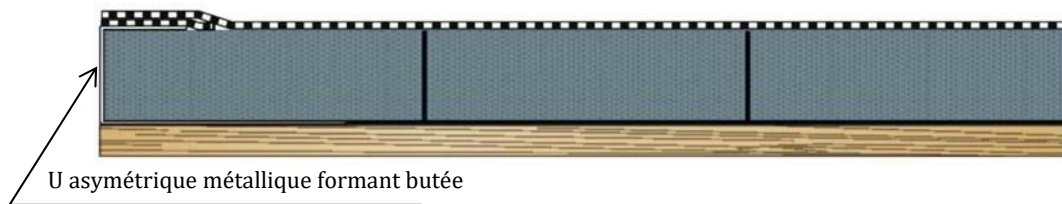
Coupe de principe sur rive sans acrotère, sur élément porteur bois - panneaux à base de bois
